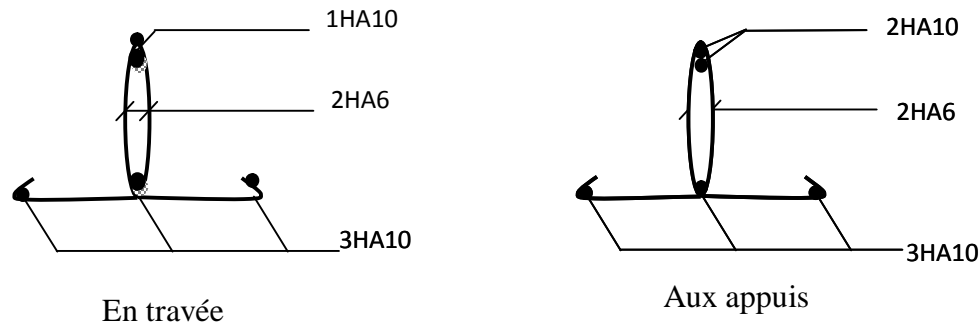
Plan de ferrailage de la poutrelle en travées et aux appuis
